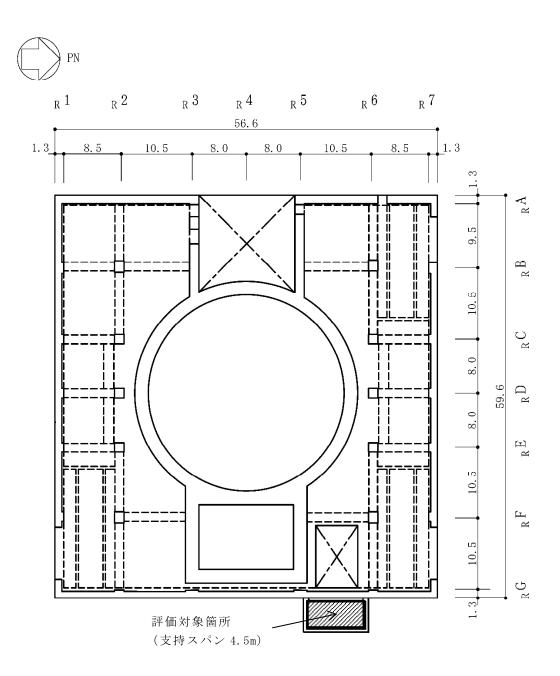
評価対象箇所 (屋根スラブ, T.M.S.L.19.6m) (単位:m)
